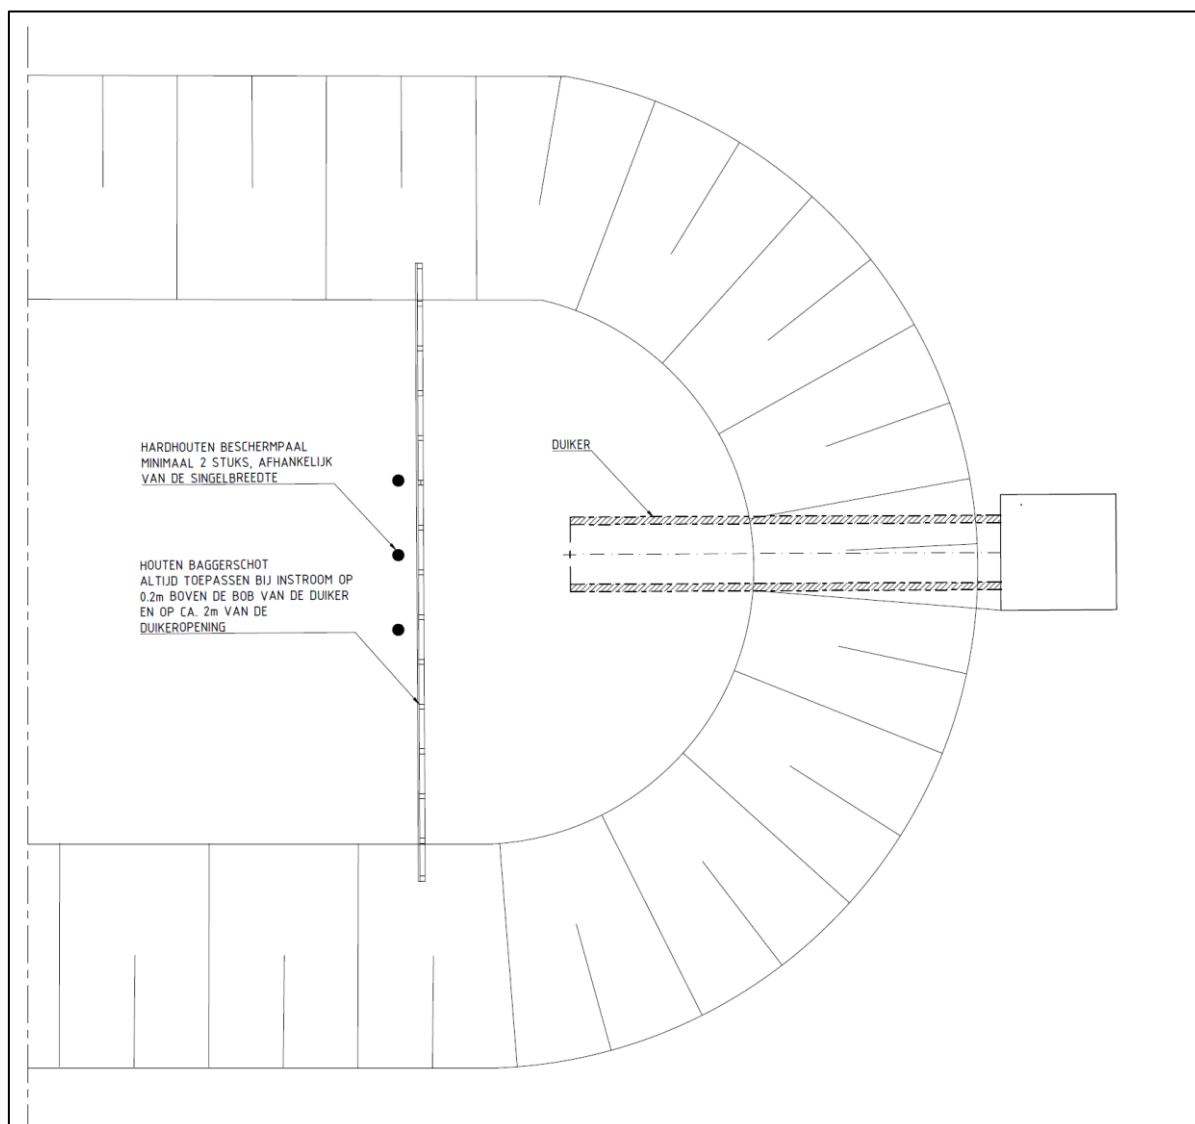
Principedetail beschoeiing (bovenaanzicht)
